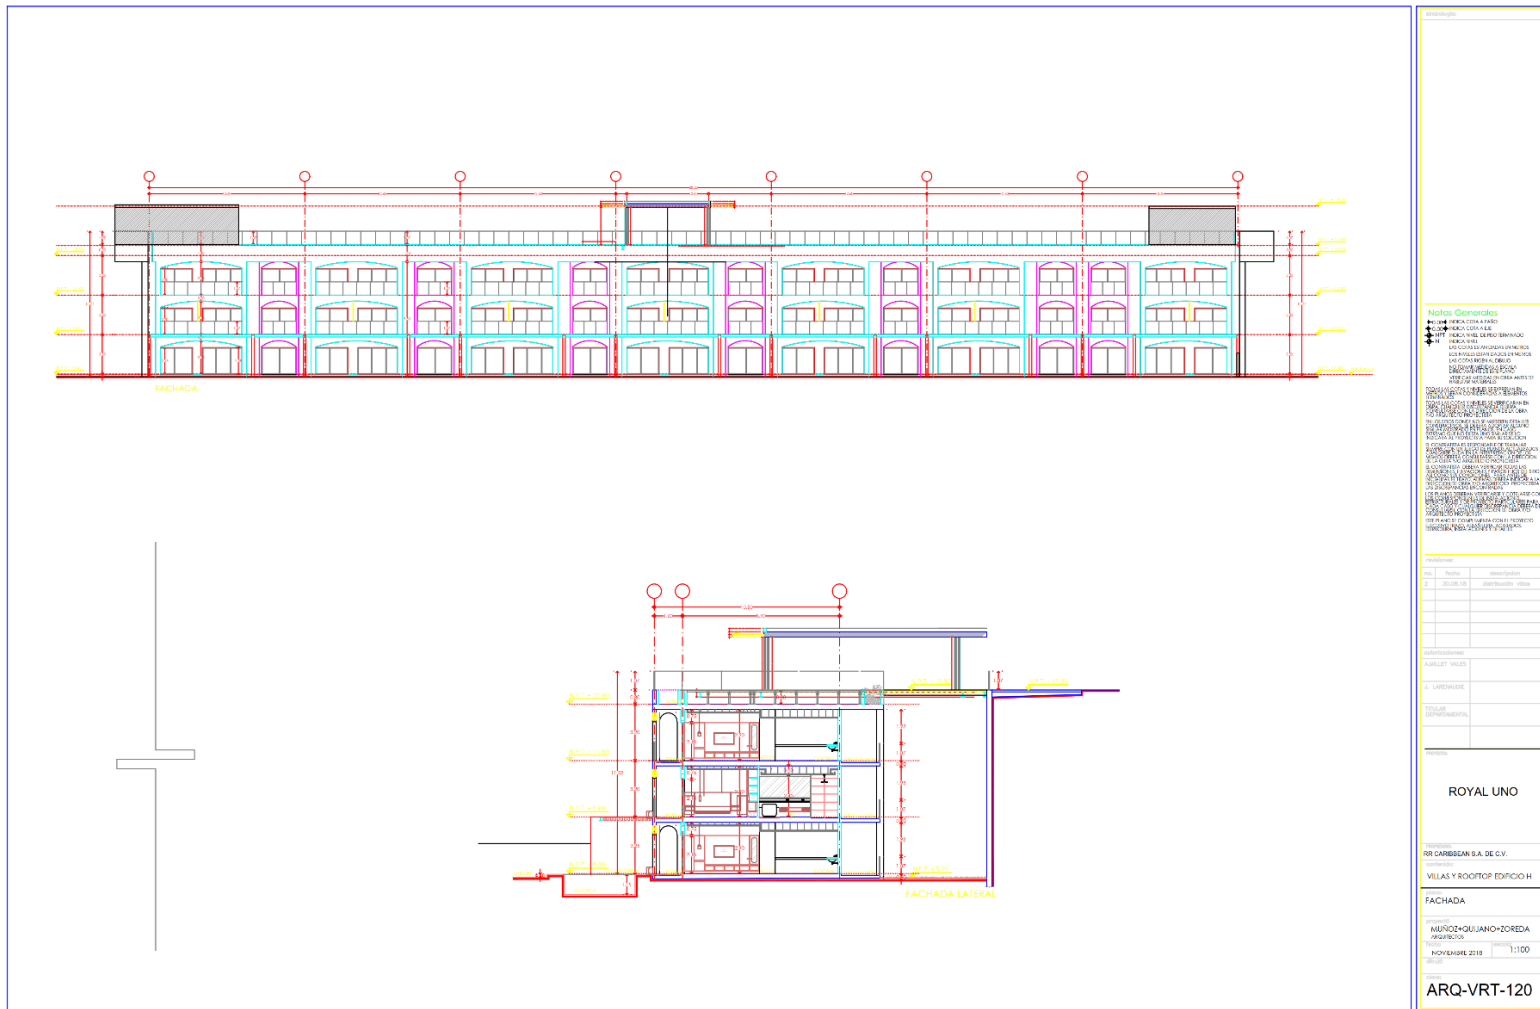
Edificio H, Fachada principal y lateral. Anexo C-7.
